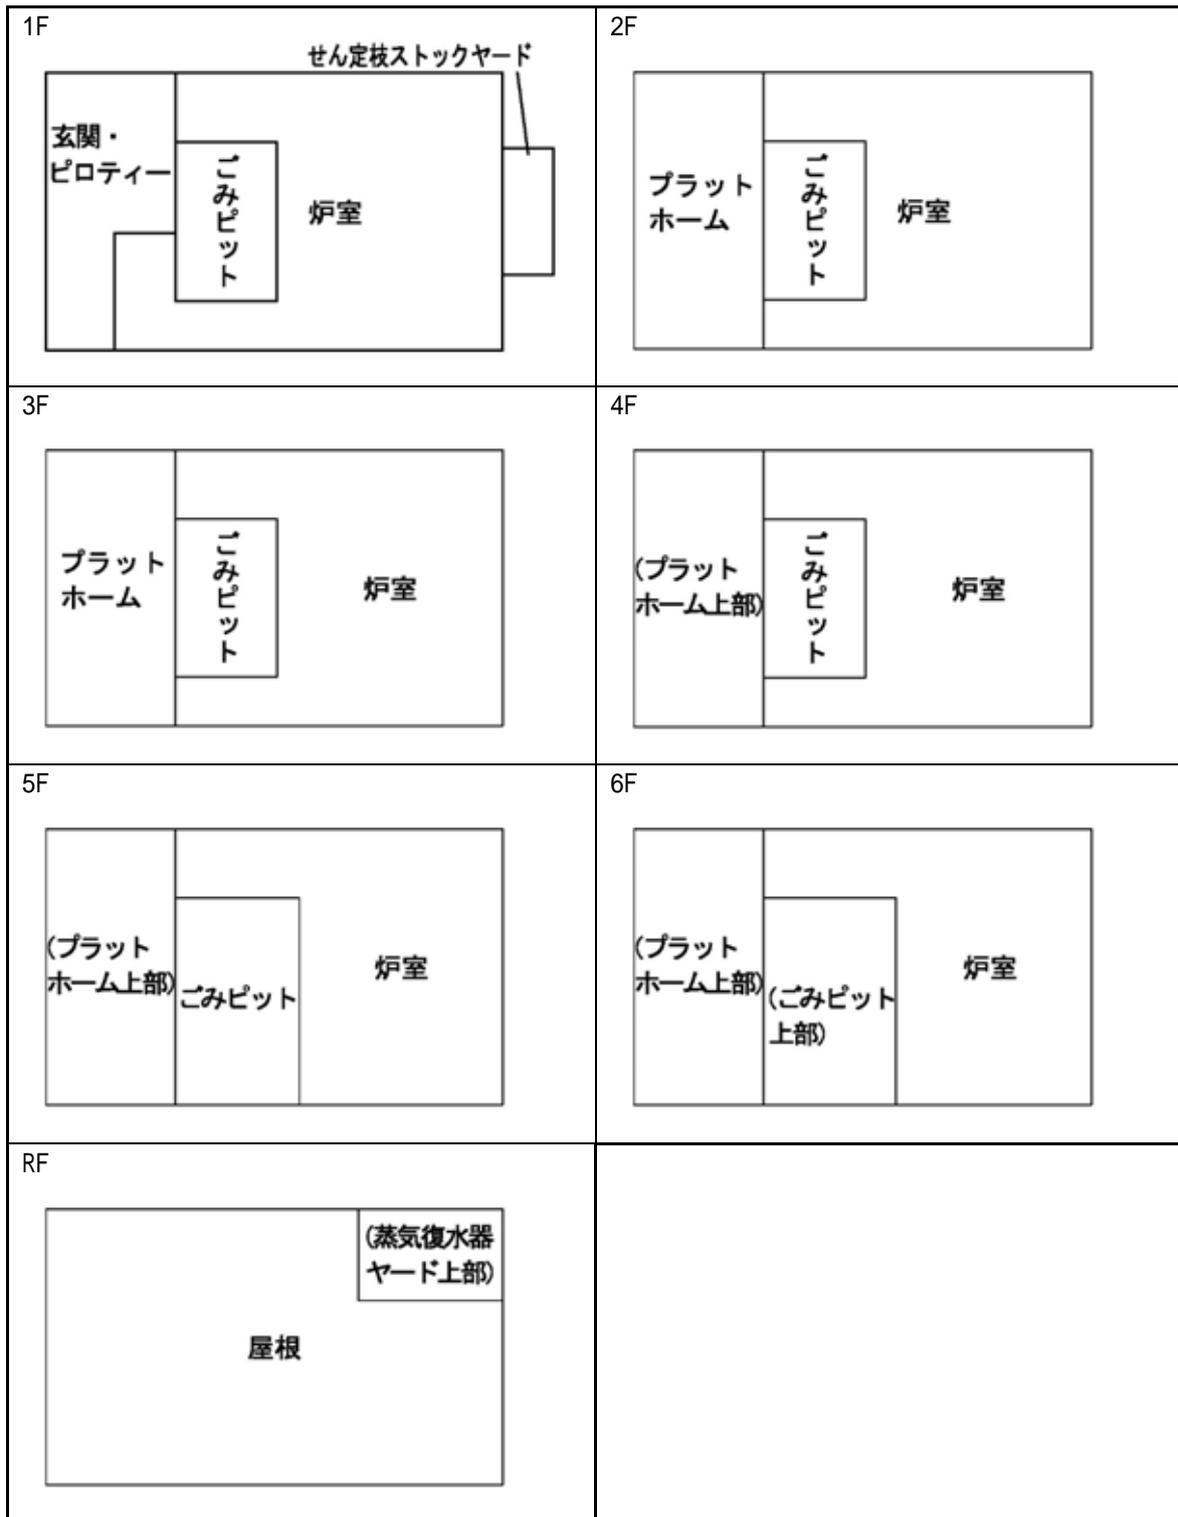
工場棟の主要施設配置概略図（平面図）
